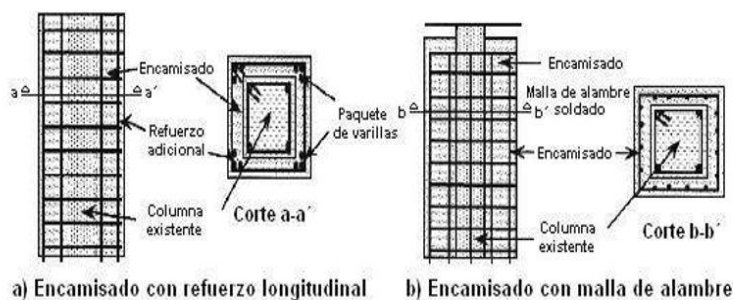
Encamisado de columnas, Fuente: (Aguilar.; Breñas.; Del Valle, E.; Iglesias.; Picado, M.; James M., 1996)
